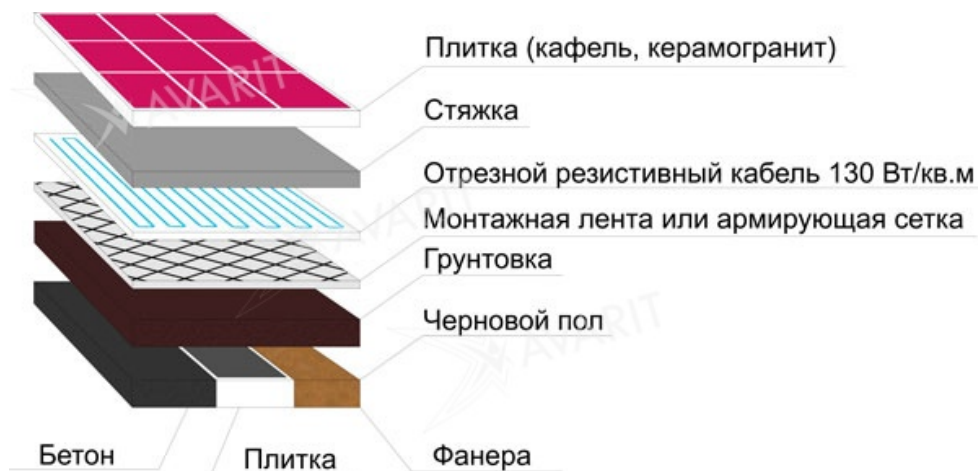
Установка нагревательного кабеля под плитку (комфортный обогрев)
